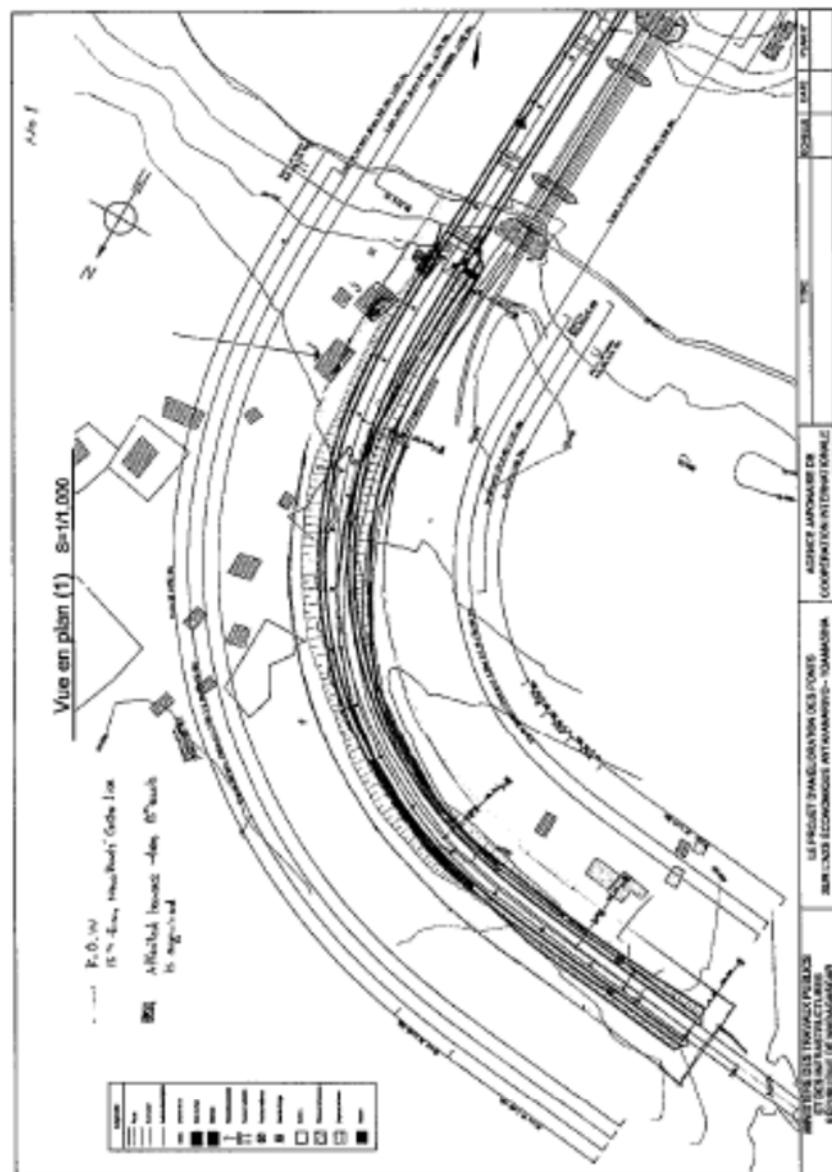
PLAN FINAL POUR MANDORO – PARTIE 1
